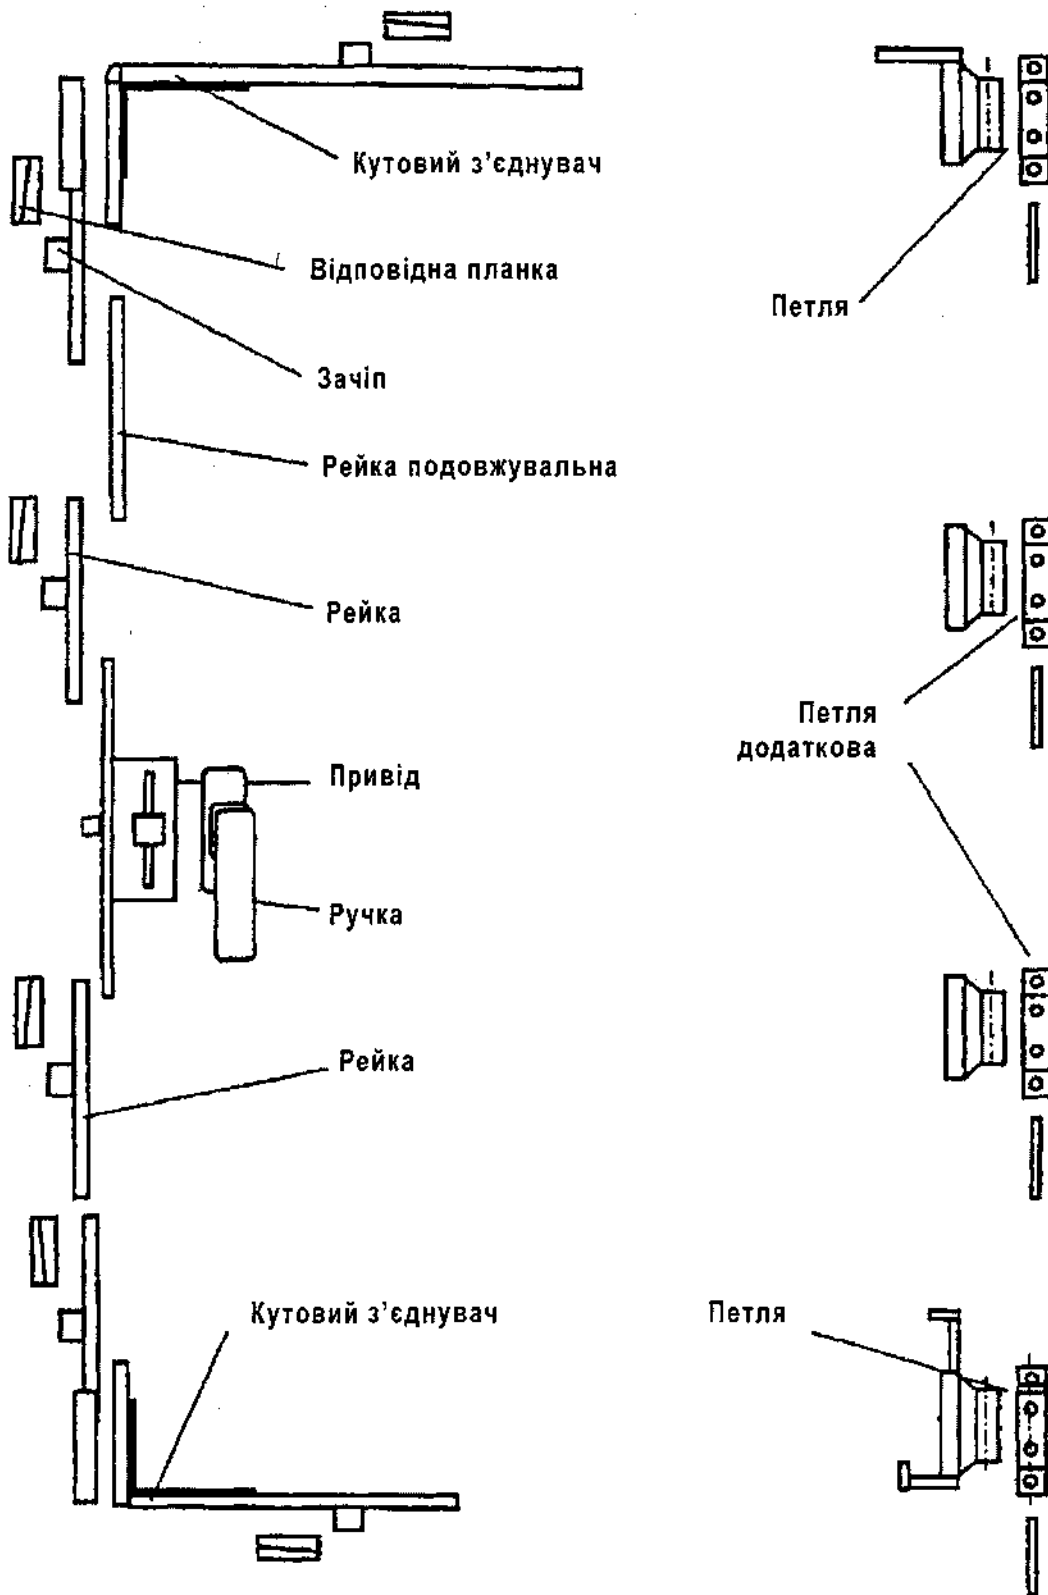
Основні деталі й вузли поворотного пристрою
